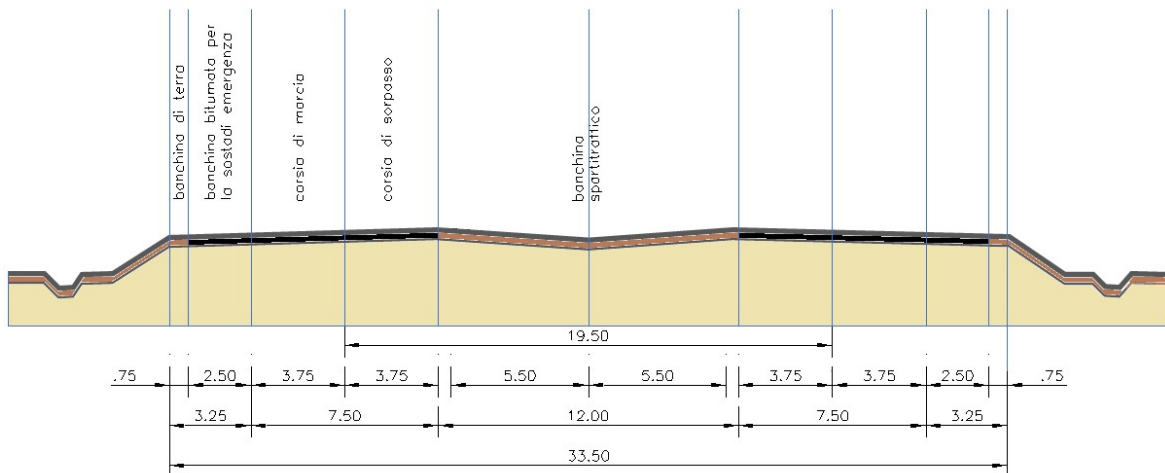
/4.1 – Sezione tipo attuale nel tratto con spartitraffico
